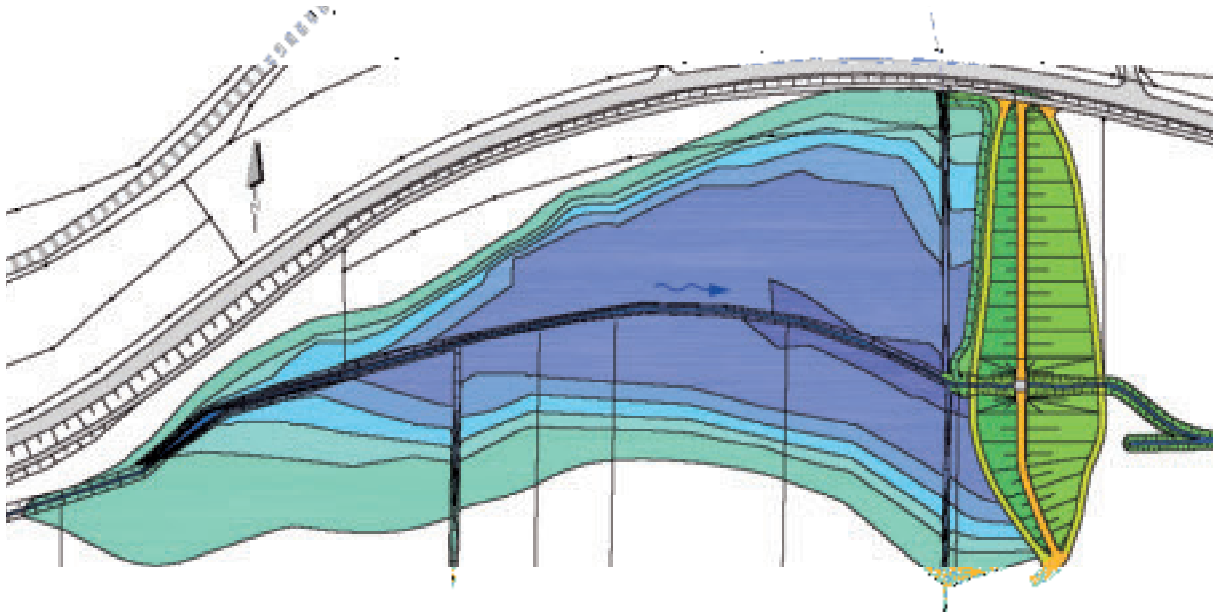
Lageplan des HRB Bödigheim / Wolfsgrundbach mit Einstauflächen
